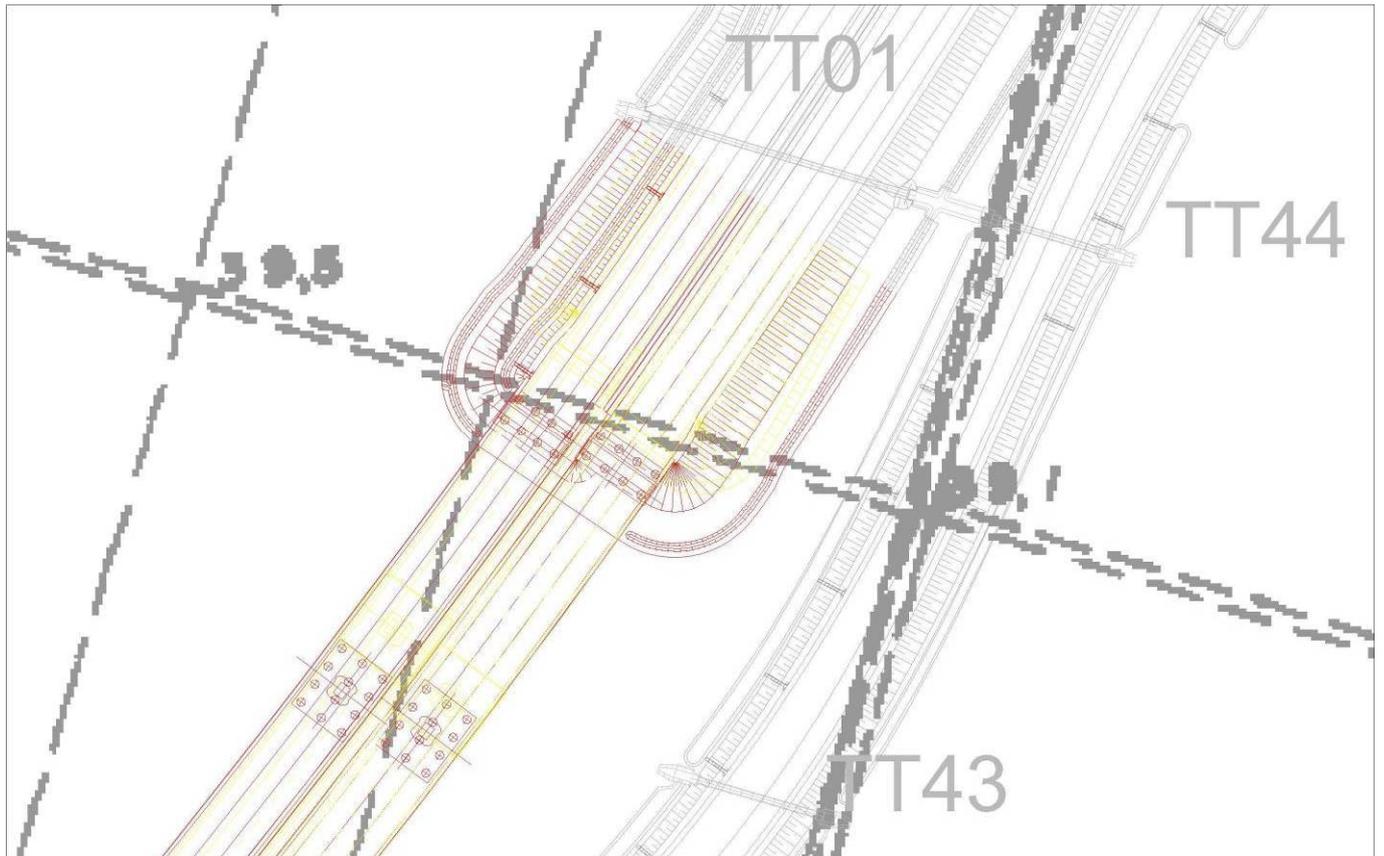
Planimetria con individuazione della variante alle spalle nord del ponte sul Fiume Taro. In giallo il tracciato da Progetto Definitivo, in rosso il tracciato da Progetto Esecutivo.
